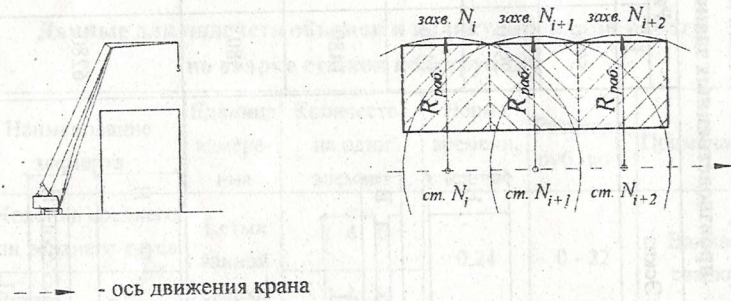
Монтаж железобетонных конструкций одним самоходным краном
